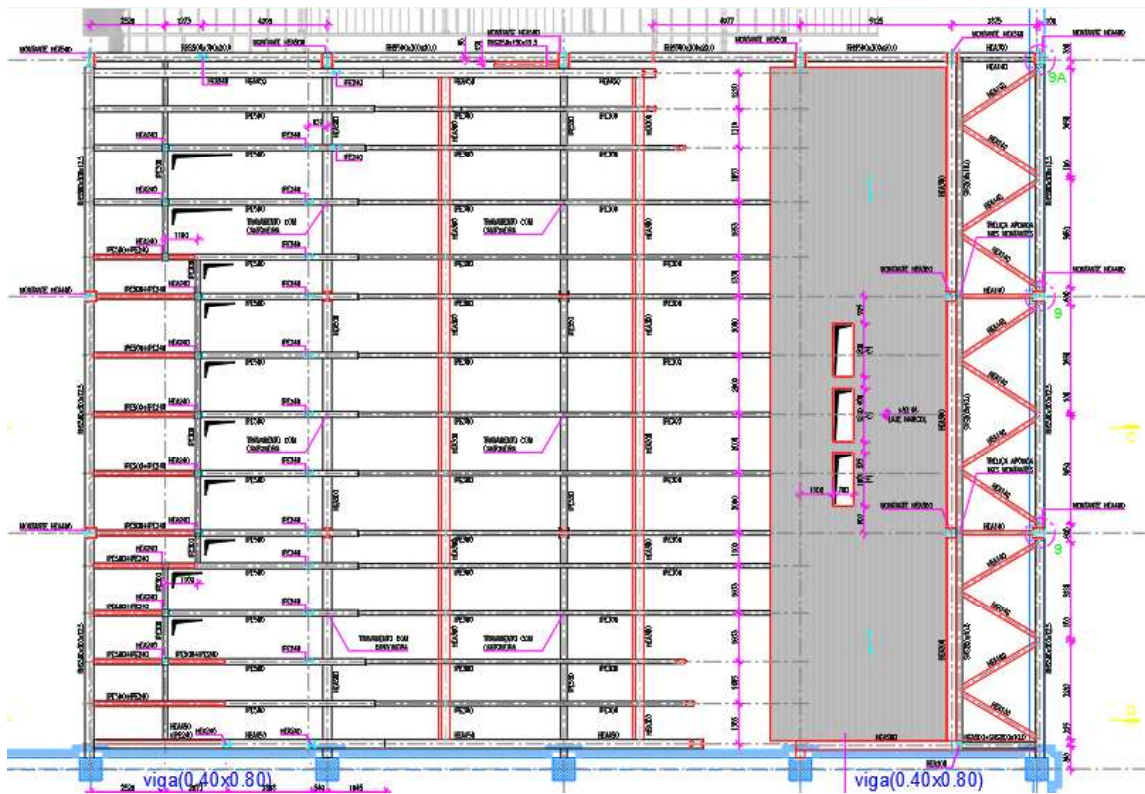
Planta baixa da arquibancada do Projeto de Estrutura disponibilizado.
